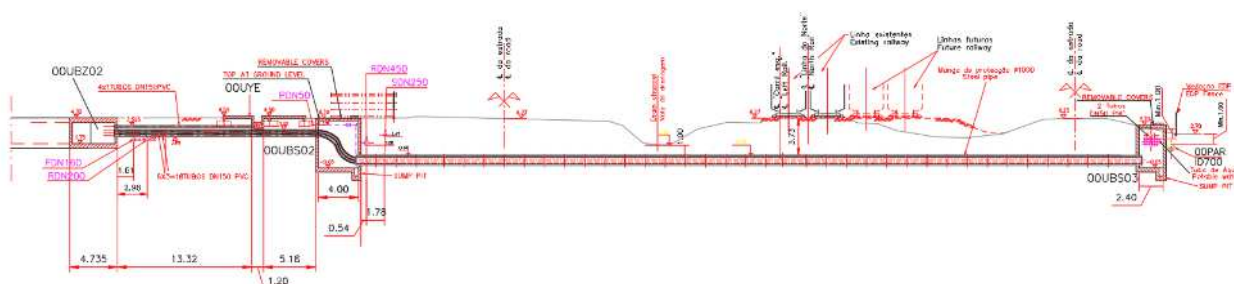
PK 37+031 e PK 37+033 – Condutas de água do sistema da torre de refrigeração (in desenho 720650)
